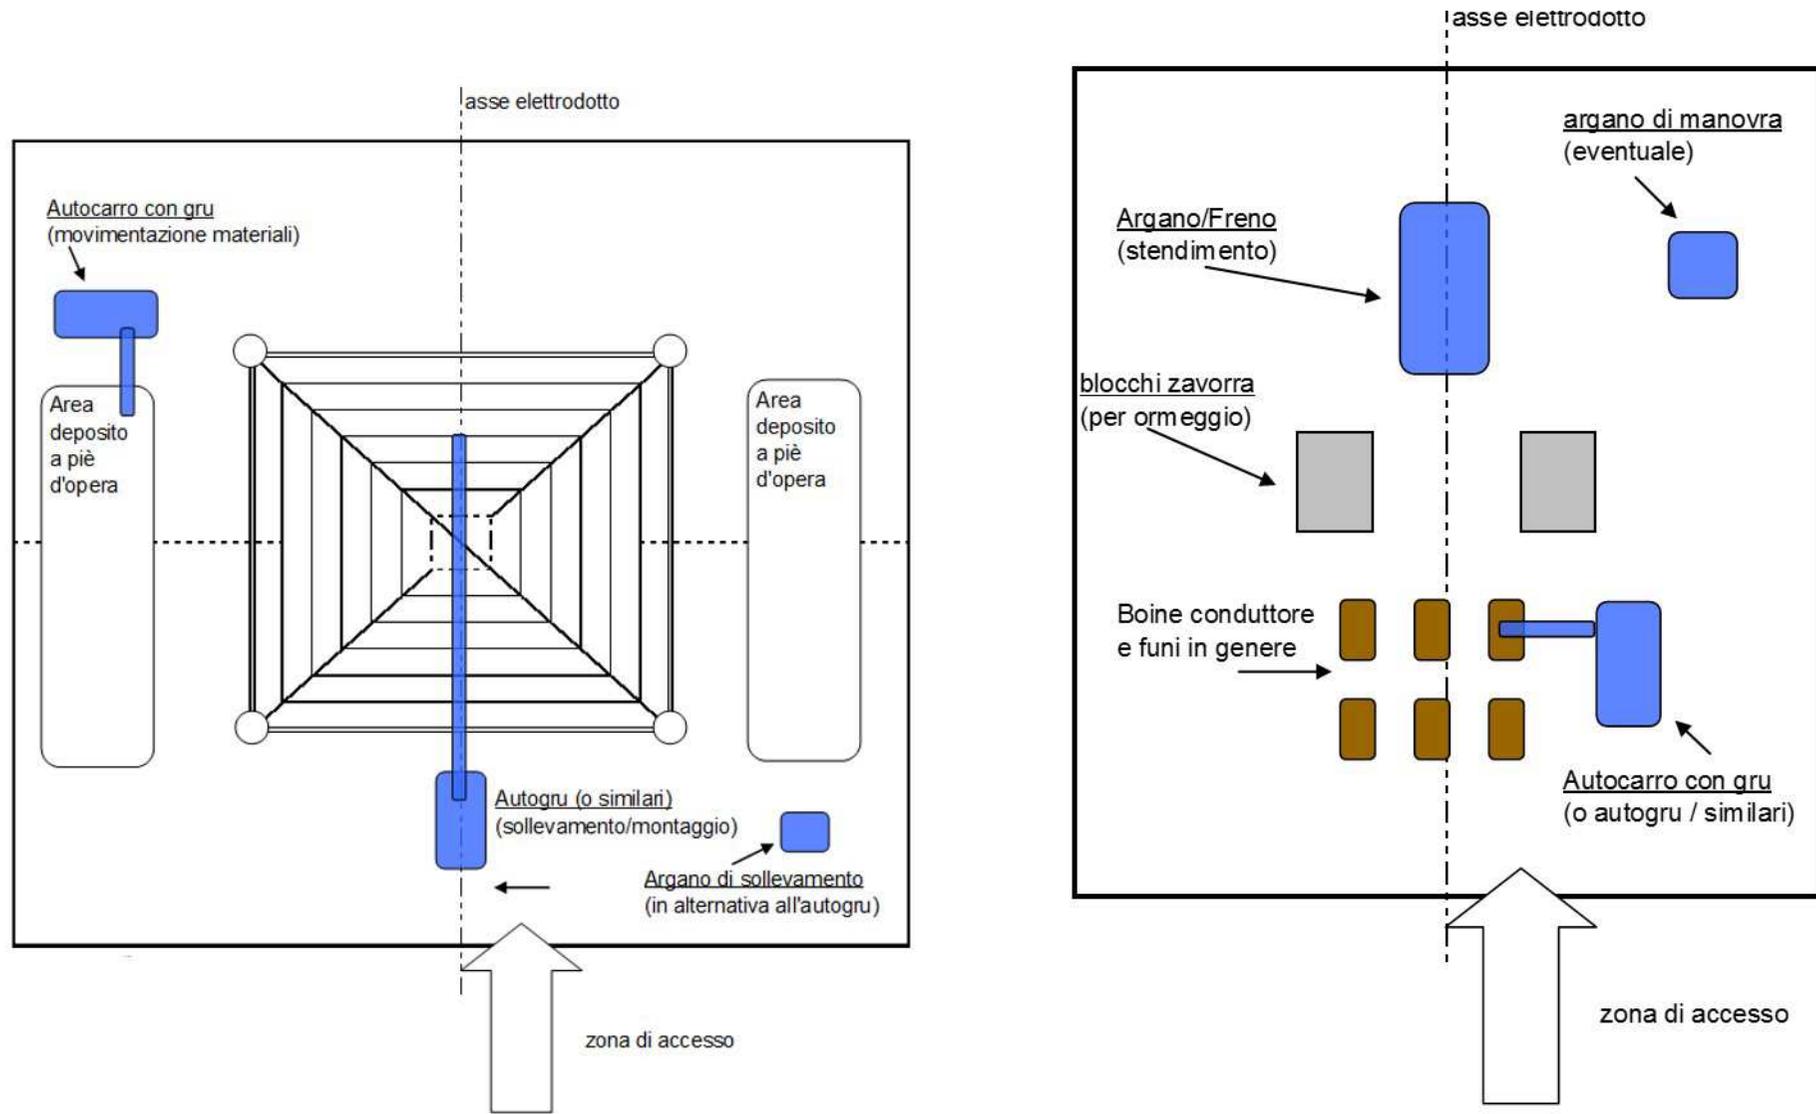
Planimetria dell'Area Sostegno (montaggio sostegno) - Planimetria dell'Area di linea - Tipologico
